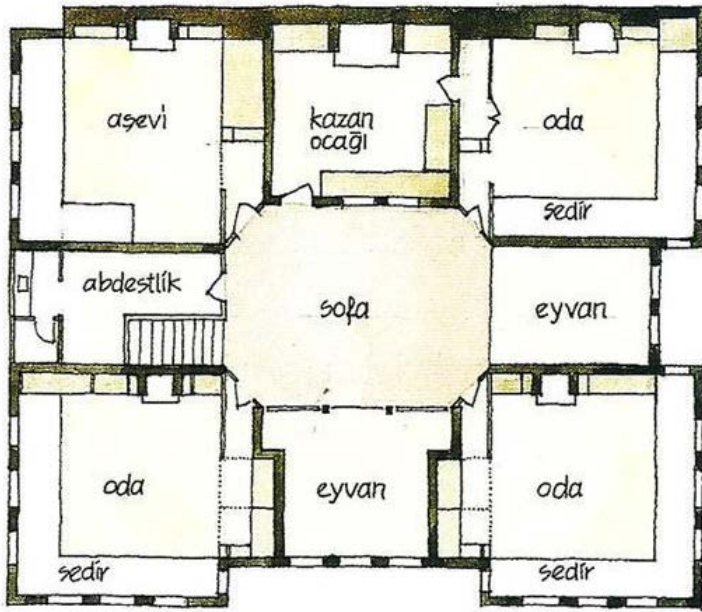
İç Sofalı plan tipleri/Sedad Hakkı Eldem
